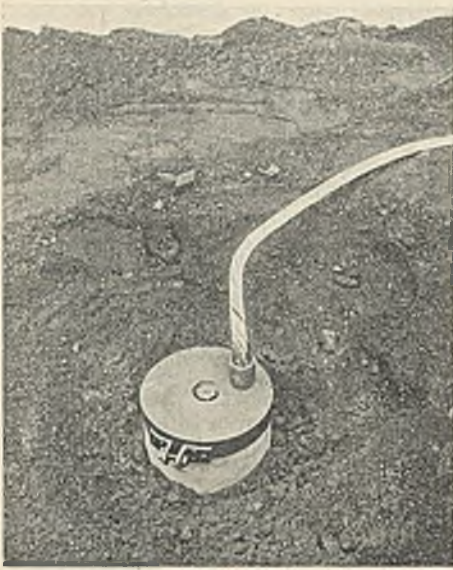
Meßdose geschlossen, fertig zum Einbetonieren.
